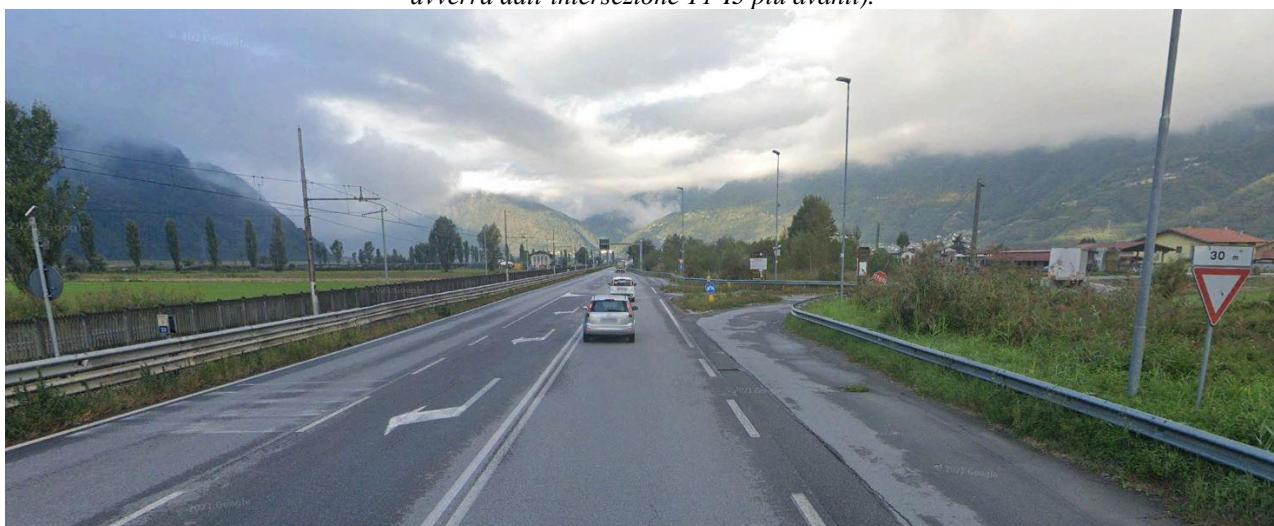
Tratta 1: Vista della SS38 direzione Colico: l'intersezione esistente sarà spostata più avanti.
